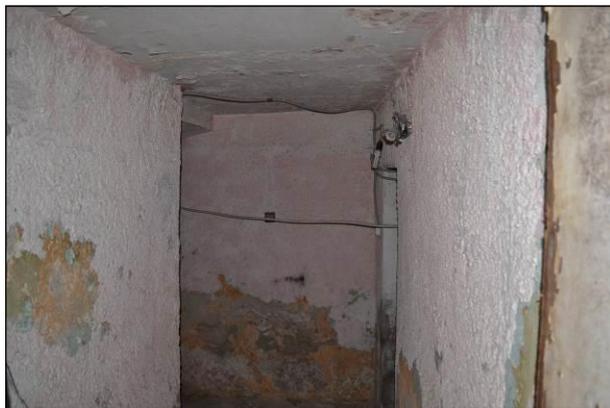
Вход в помещение из парадной (часть помещения 7 по плану)
